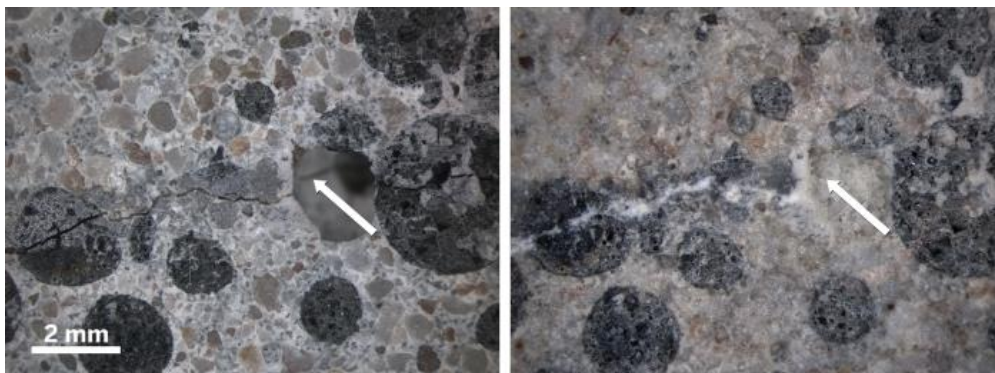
Tipovi prirodnog samozacjeljivanja betona [12]
